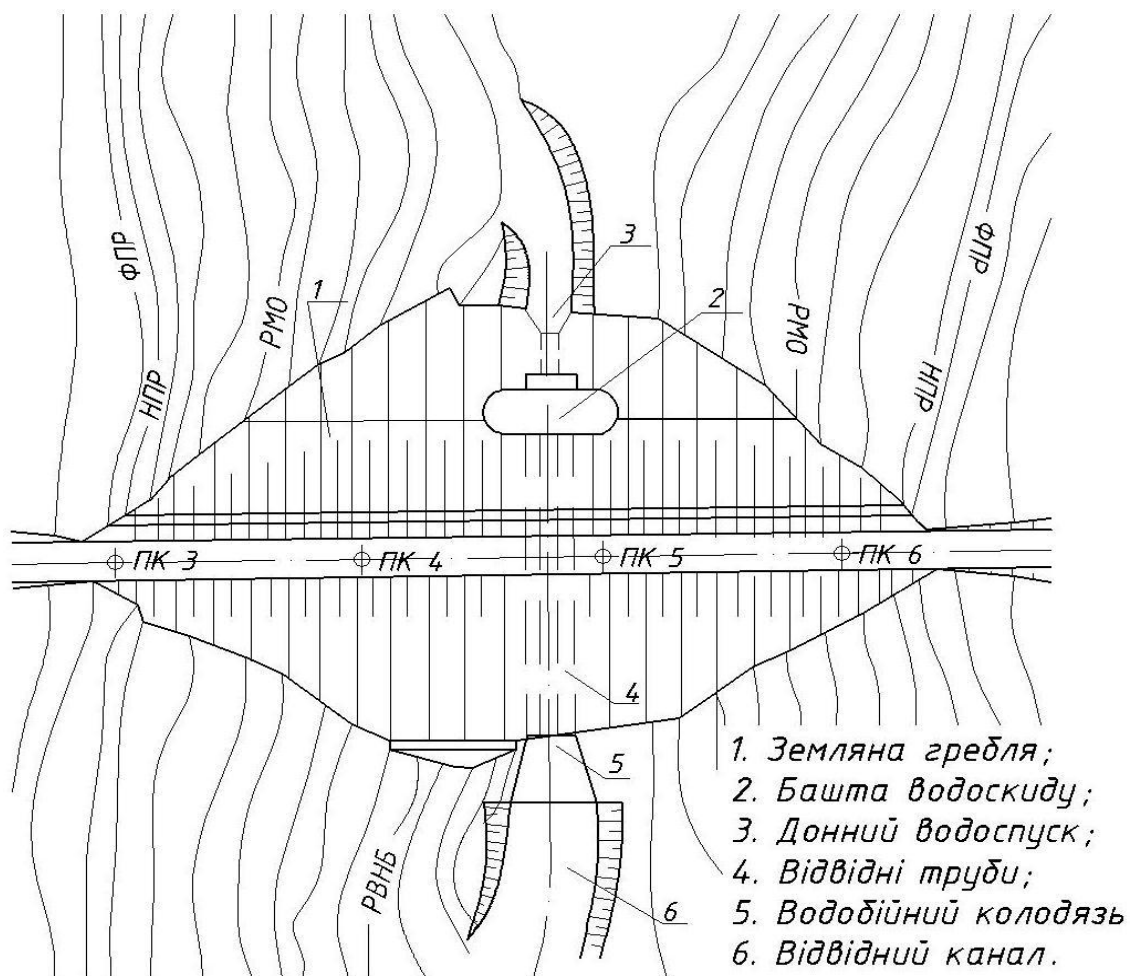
План гідровузла з баштовим водоскидом
